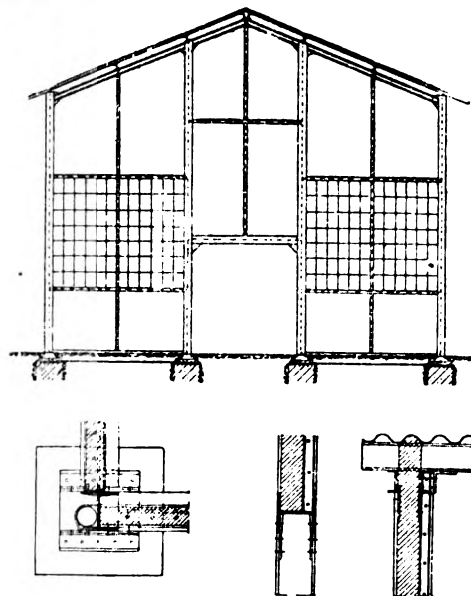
, 38, 39 e 40 — Tipo di fabbricato armato di poutrelles ad ali larghe.
